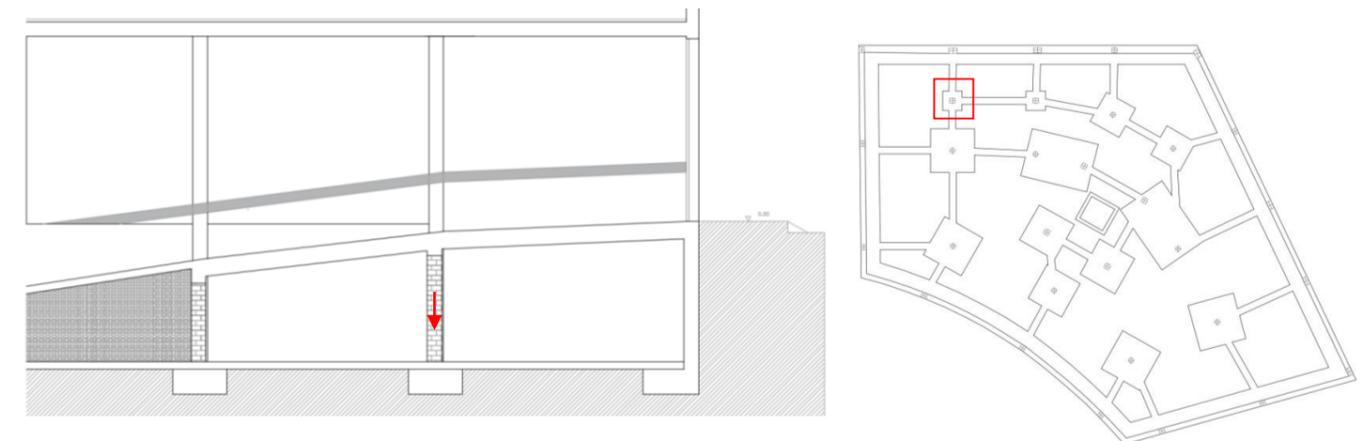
Asentamiento de zapata aislada. 2018. Elaboración propia
